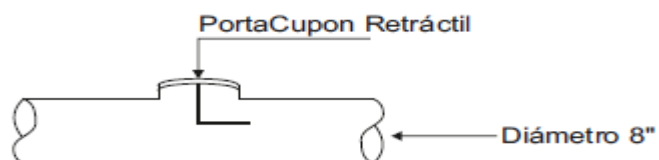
Detalle tubería a la salida del tanque de desarenado. Fuente: Los autores.
